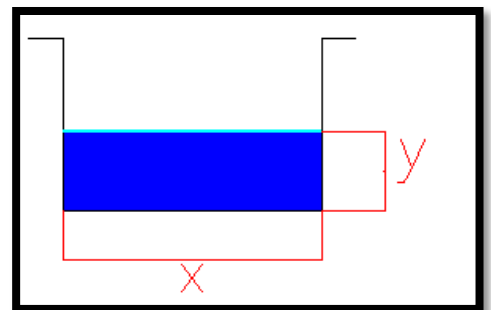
Sección transversal de canaleta rectangular con su ancho "x" y su tirante hidráulico "y".
